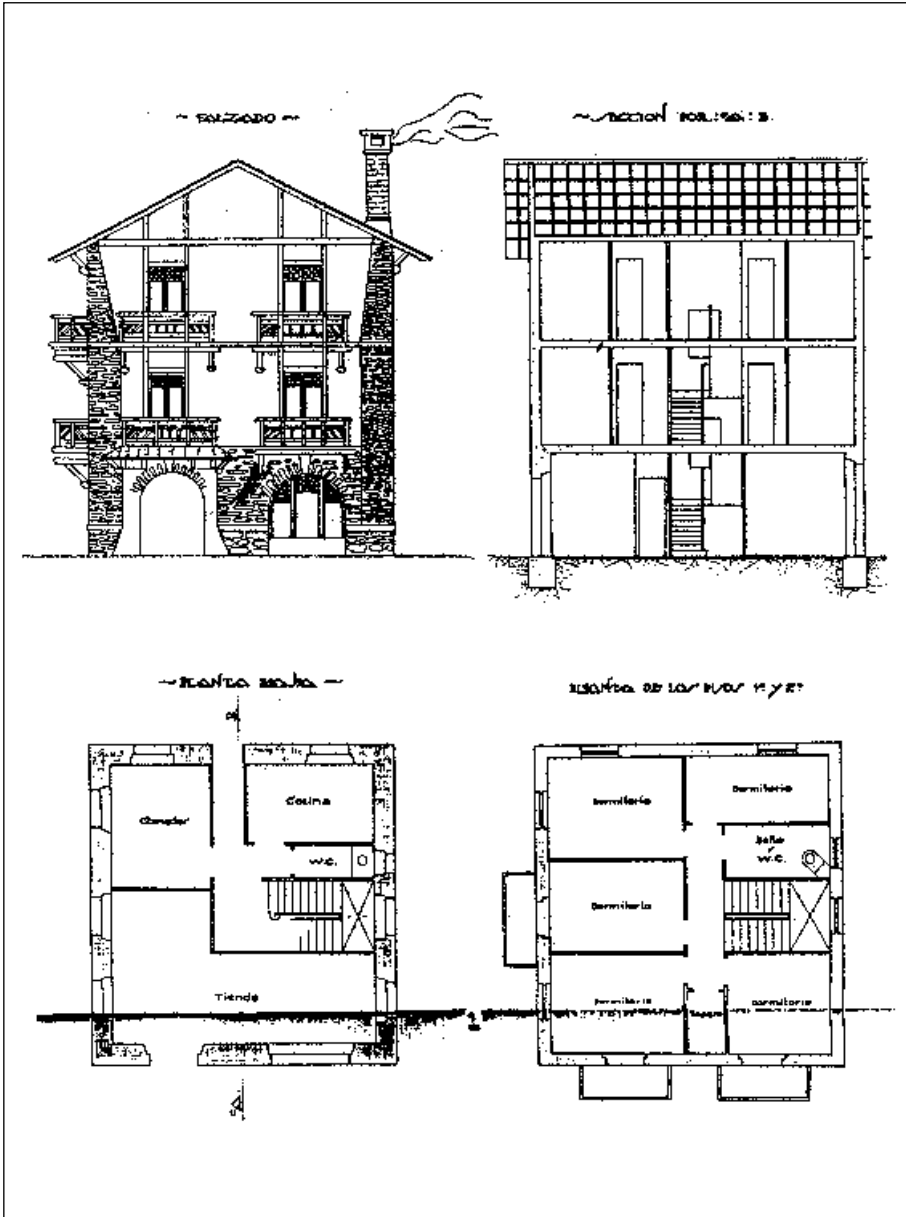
Planos que el arquitecto Guillermo Eizaguirre proyecta el 21 de agosto de 1922 para José M^o Mendizábal.
